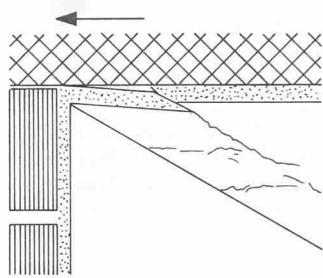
Rissbildung im Deckenputz unter der obersten Geschossdecke, bedingt durch Dehnung der Betonkonstruktion und durch das Fehlen des Schwedenschnittes
